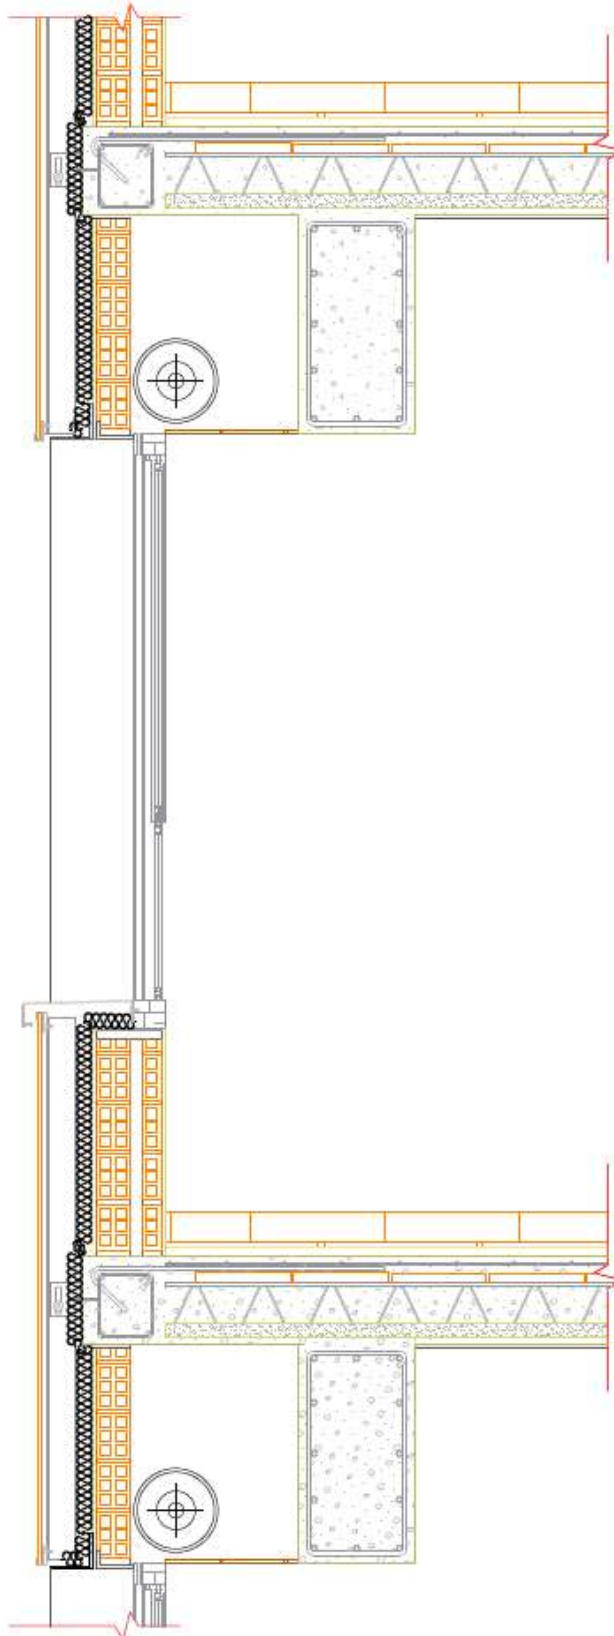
Sección cerramiento rehabilitado con fachada ventilada, (Fuente: autor) * ver plano nº 13
